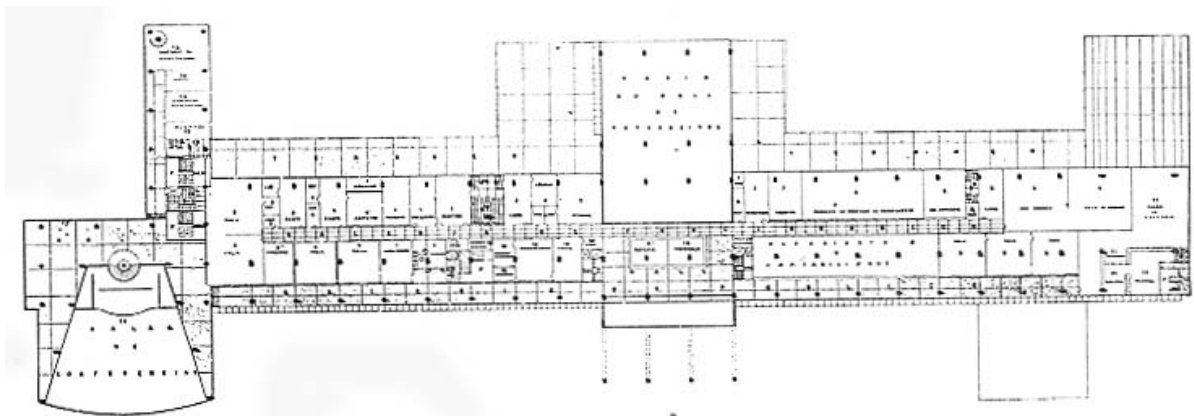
Anteprojeto de Lima, Almeida e Santos - planta baixa do 1º pavimento.
